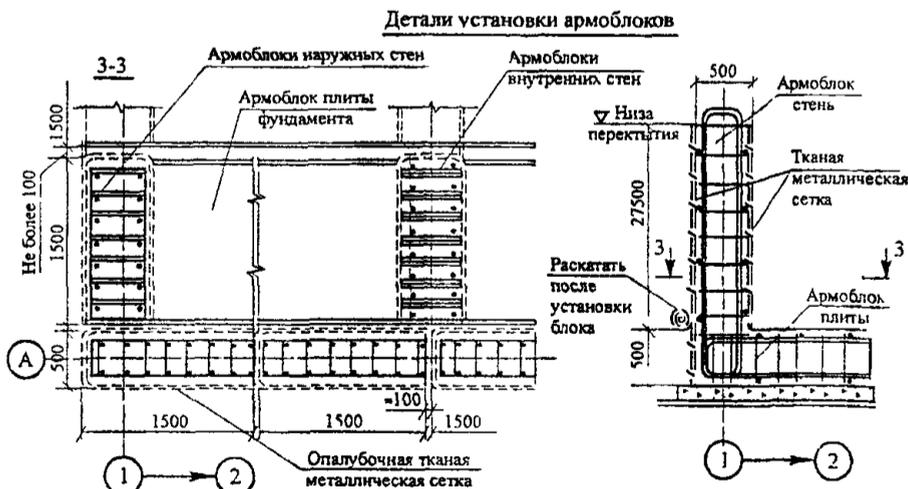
Схемы раскладки арматурных блоков и последовательность монтажа опалубочных блоков
